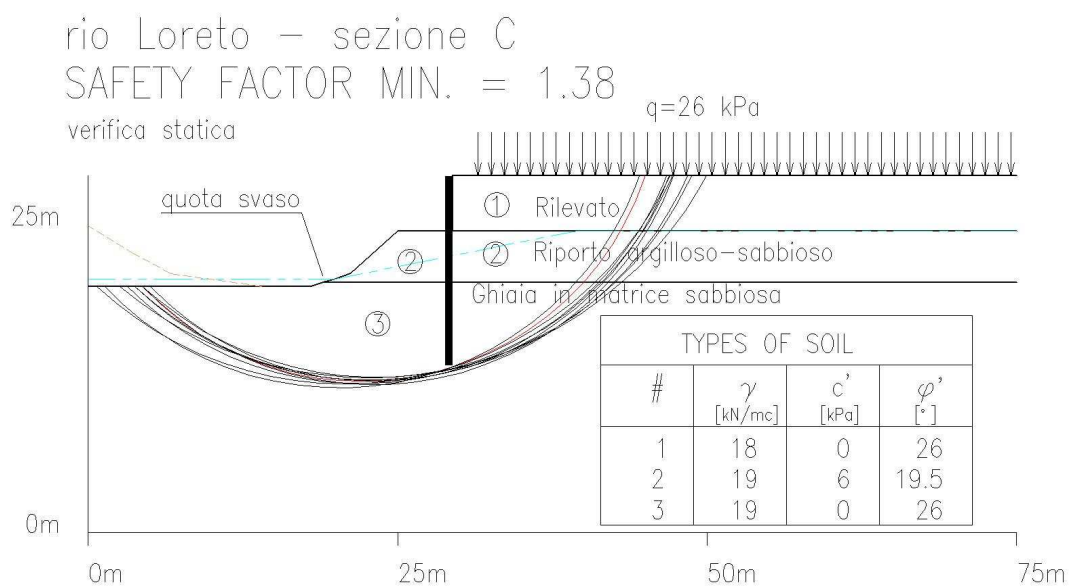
Rio Loreto Muro sezione C SVASO – verifica complesso muro terreno
